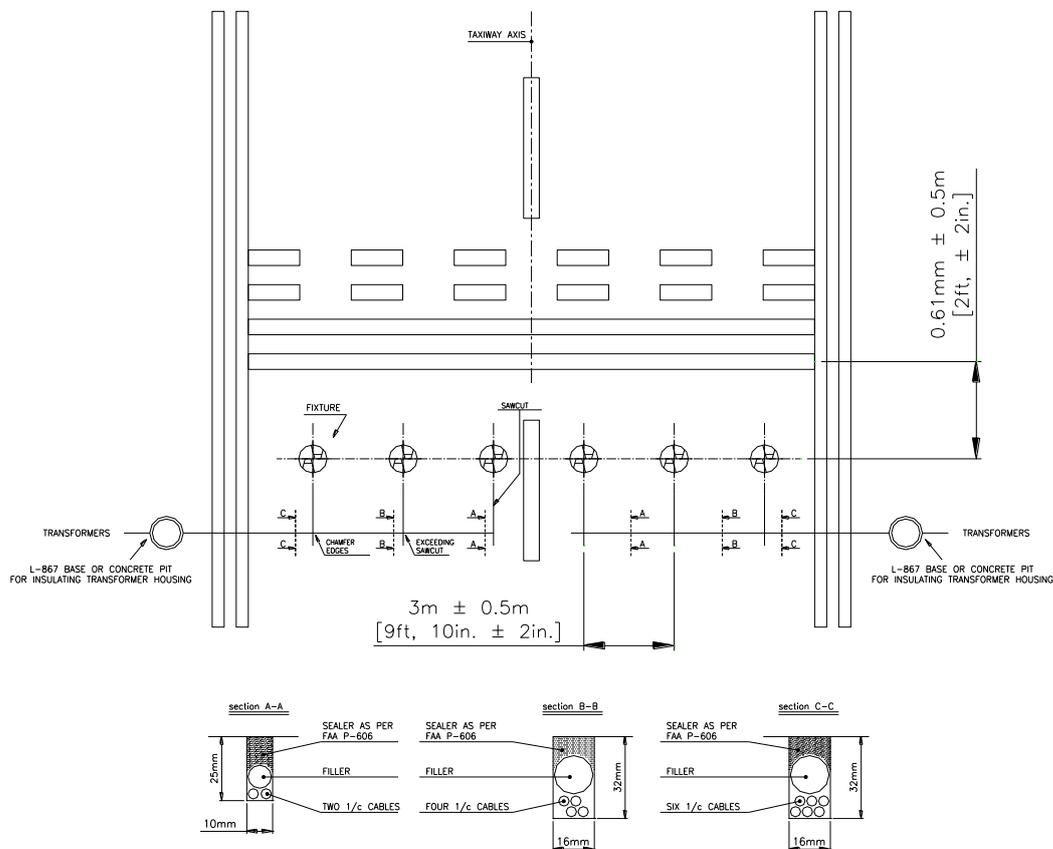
Barre d'Arresto (OACI) Schema di Disposizione dei Segnali
